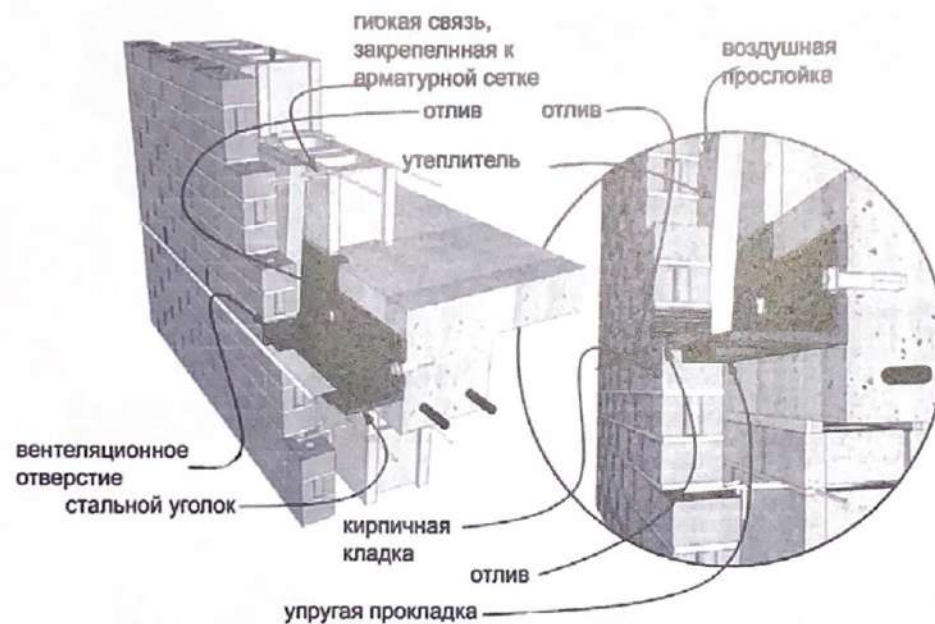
Типичная конструкция трехслойной стены с поэтажной разрезкой [1.23]
